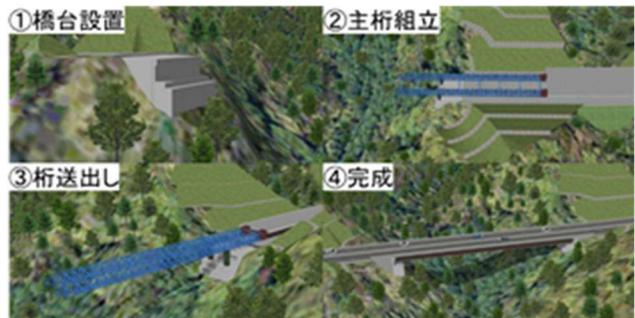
CIMモデルを活用した施工ステップ確認 (貝岡川橋 (仮称))
